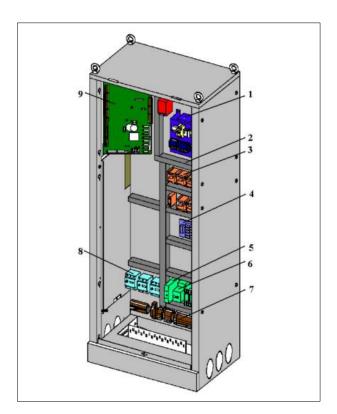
Partes de maniobra del ascensor *Fuente:* Manual de Schindler
